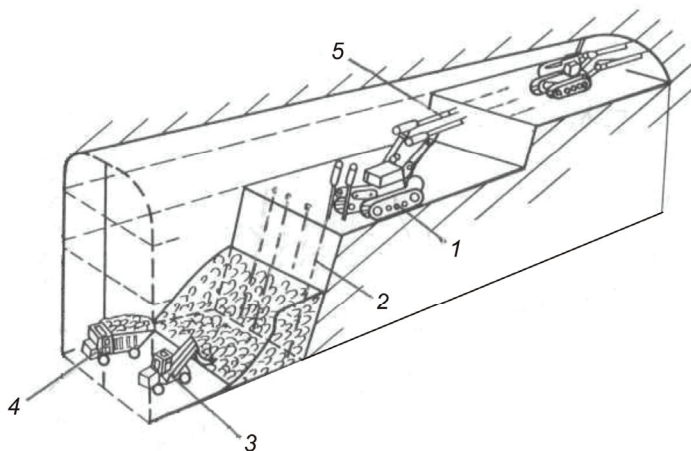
Схема проведения горных работ при сооружении нефтехранилища:
